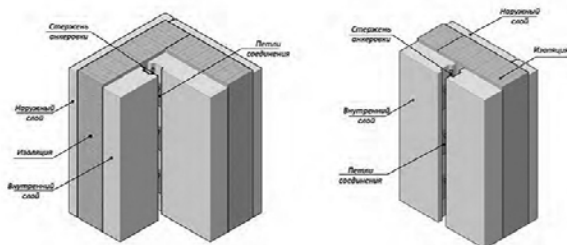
Перекрытие изоляционного слоя без «мостиков холода» в стеновых панелях
